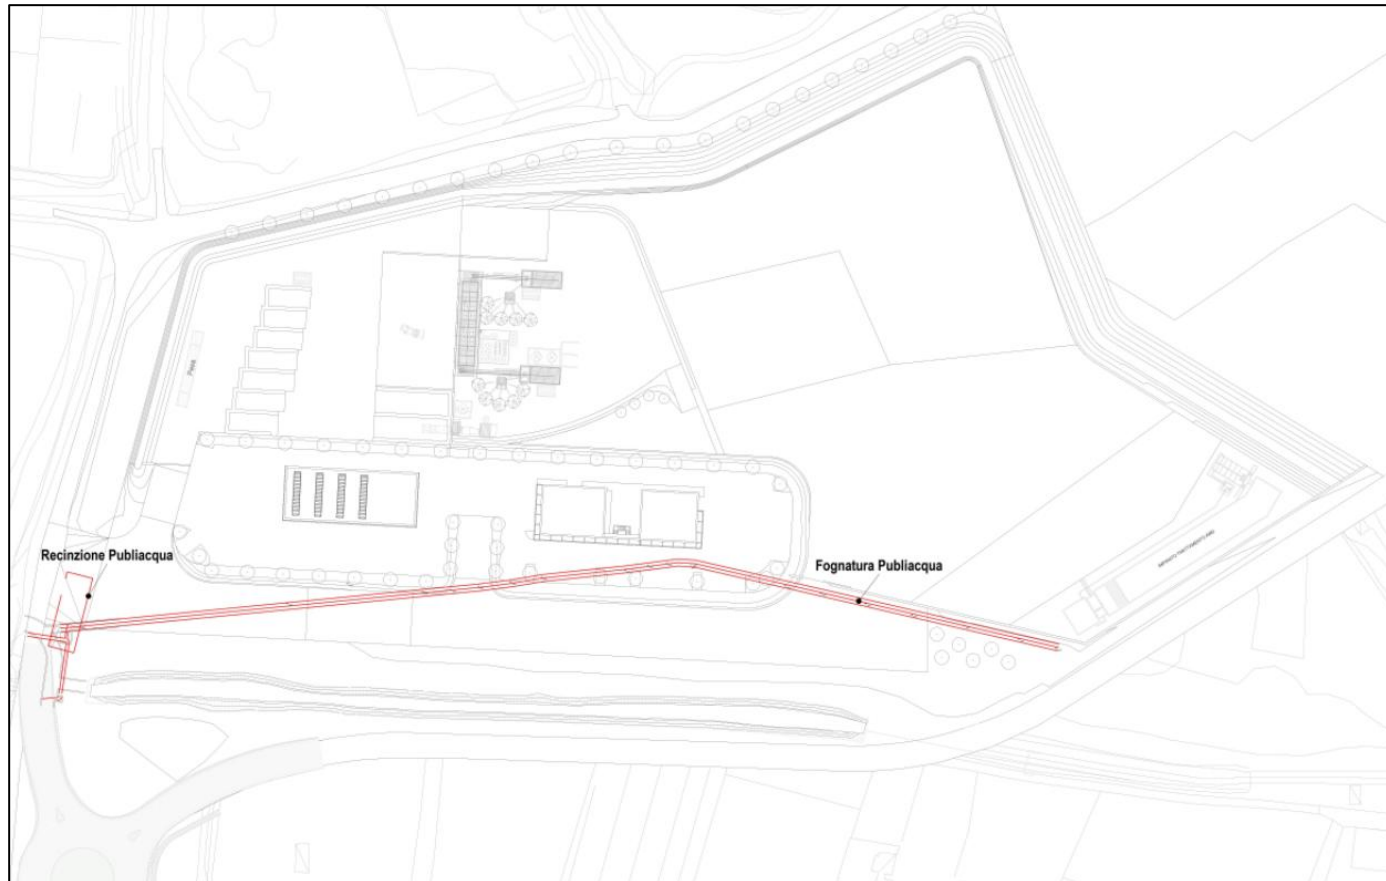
Planimetria con individuazione della fognatura pubblica di proprietà Publiacqua
